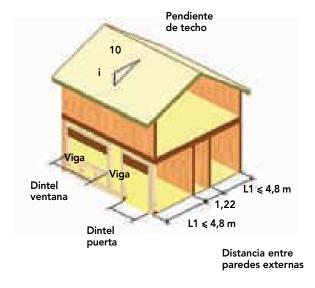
Dimensionamiento de dinteles de paredes exteriores de primer nivel en viviendas de dos pisos.
